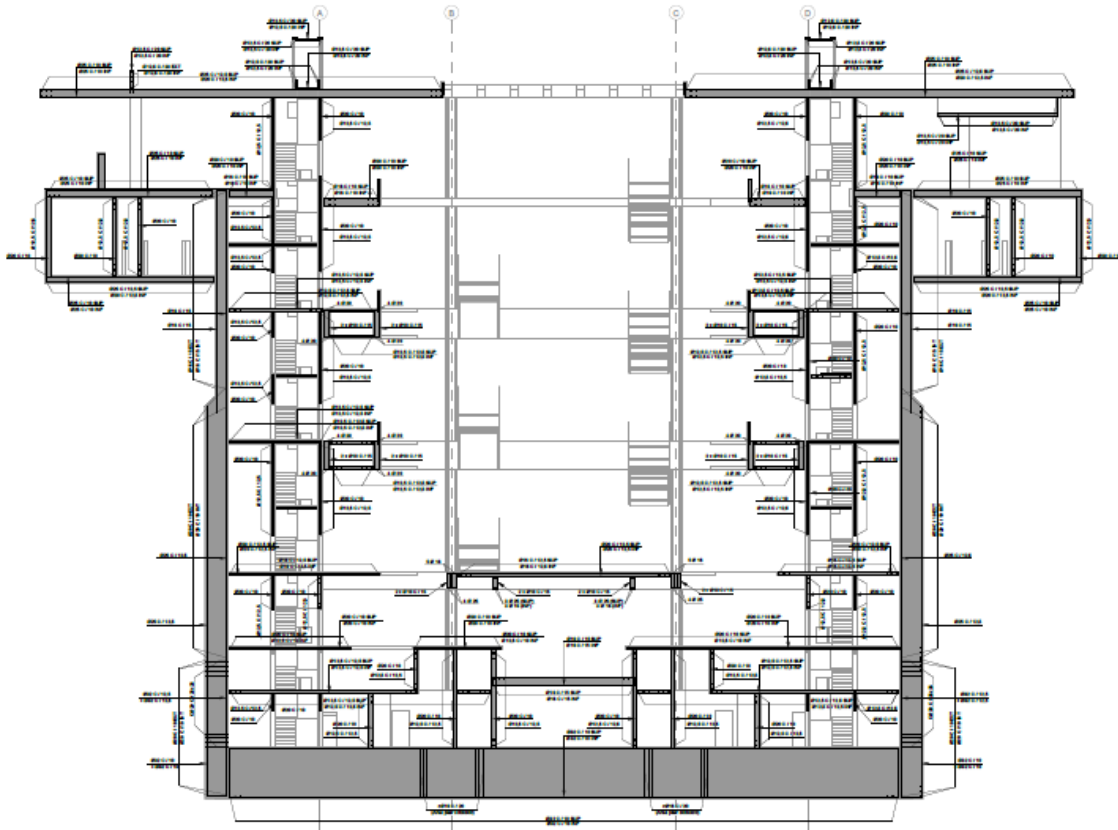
Seção transversal de uma estação, com armadura típica em projeto básico
